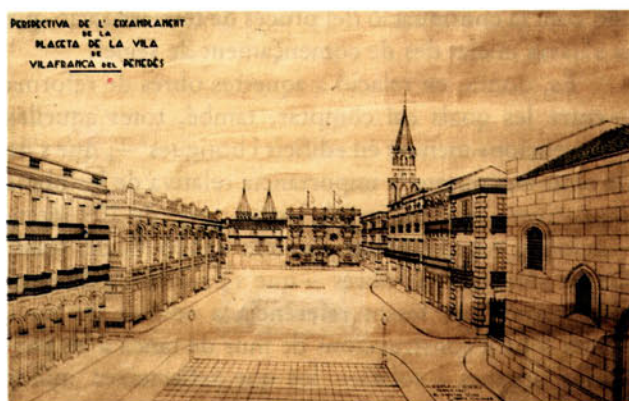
Projecte d'exemple de la plaça de la Vila, de Barenys (1934)
